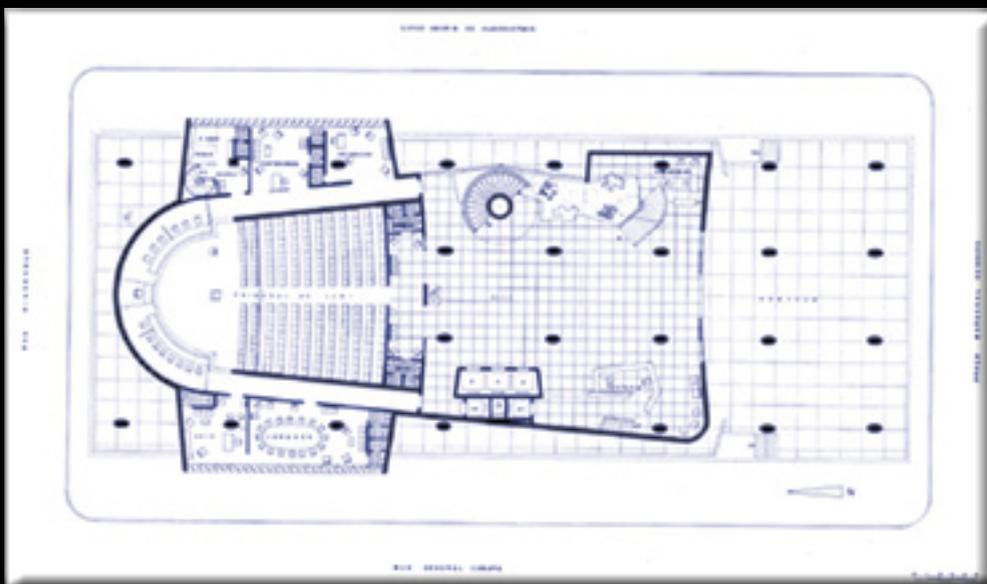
Planta do pavimento térreo. Projeto de 1952.
